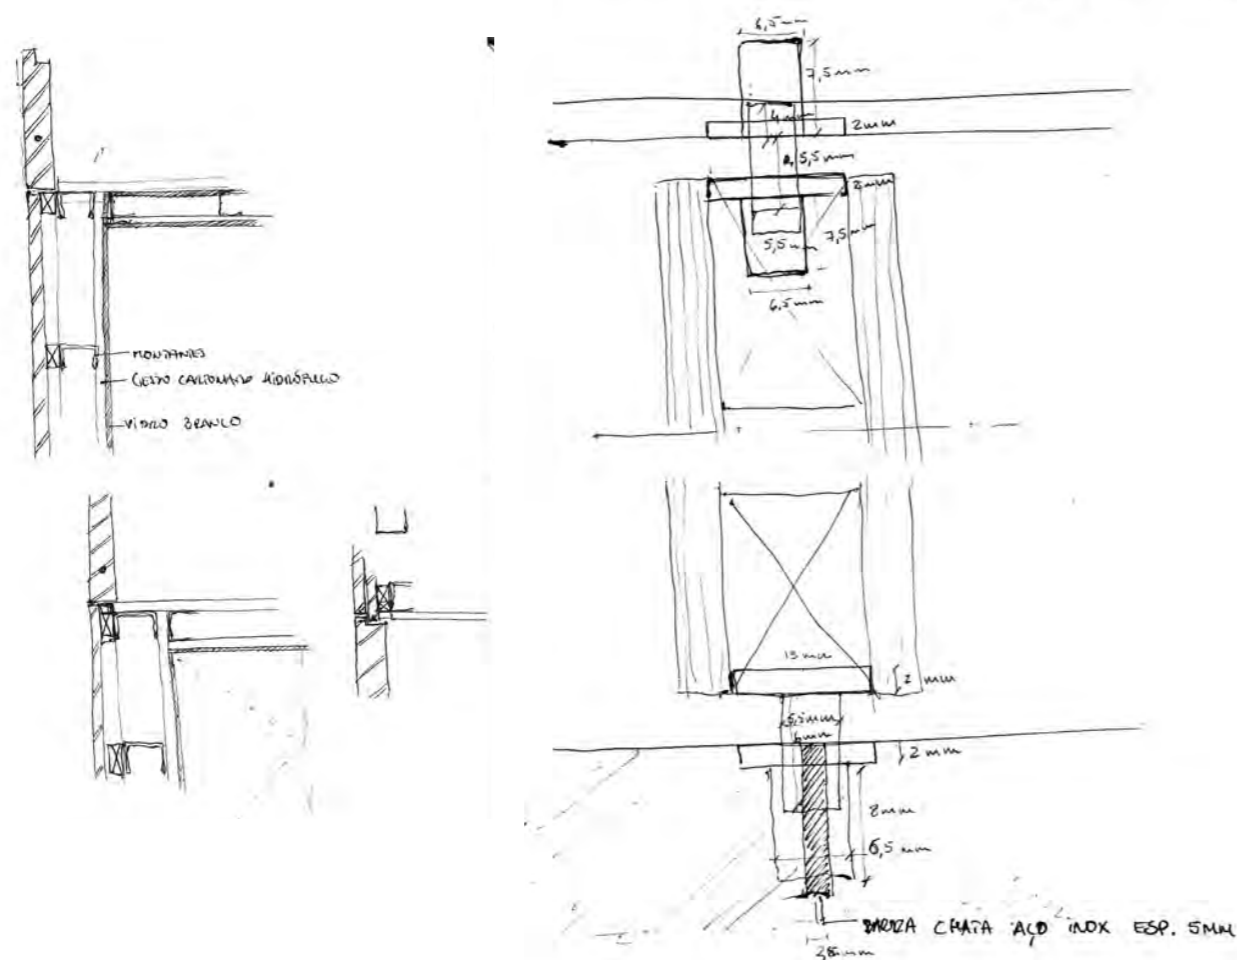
Esquissos de pormenores construtivos, detalhe de ferragens do duche e mecanismos de porta pivotante.
